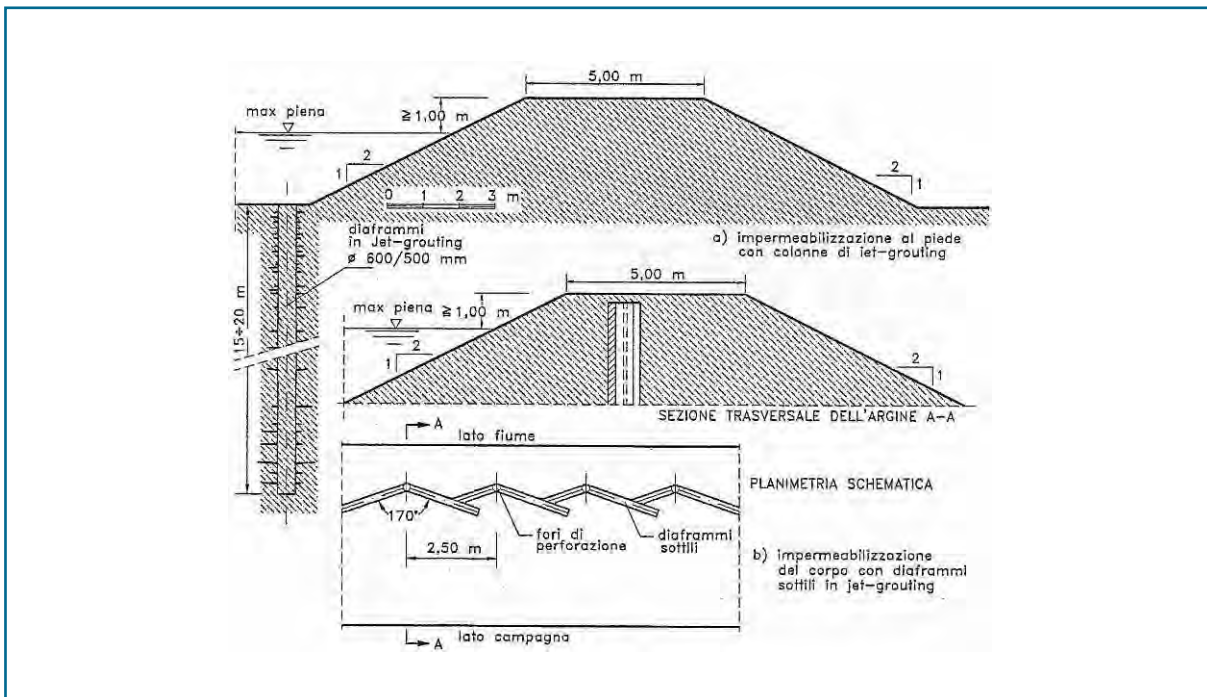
Impermeabilizzazioni arginali con la tecnica del jet-grouting [Da Deppo, 1996].
